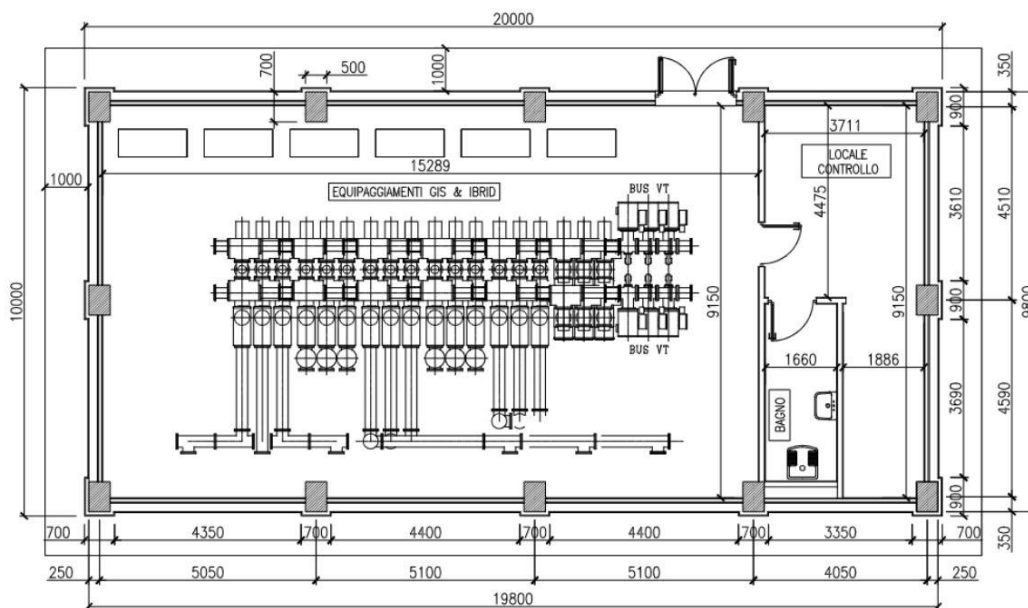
Vista in pianta tipico stazione di sezionamento
